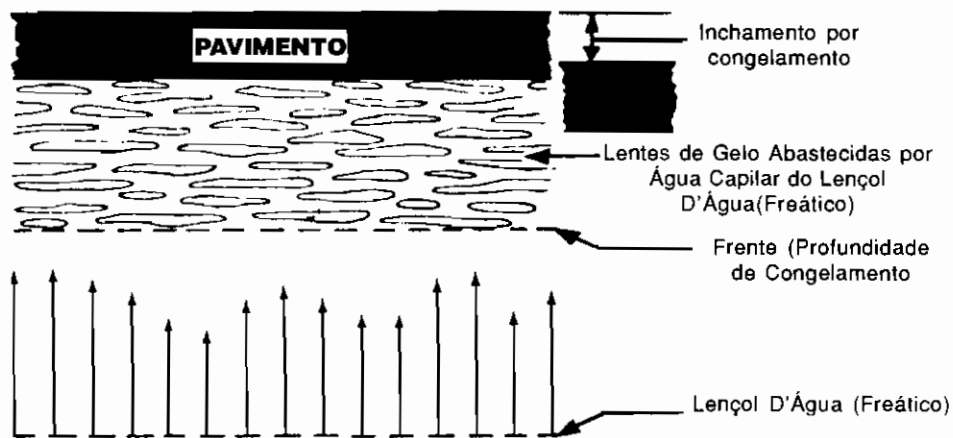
O Inchamento por congelamento é causado por lentes de gelo formadas abaixo da estrutura do pavimento
